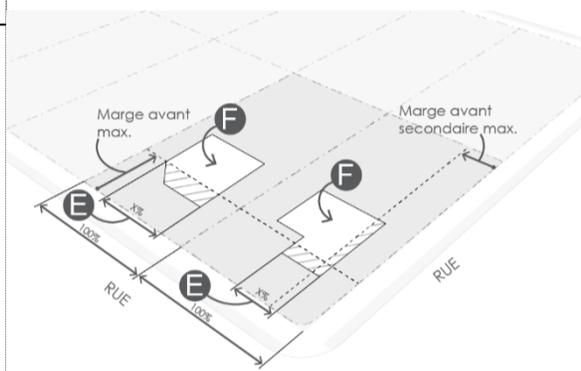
Front bâti et superficie d'implantation au sol d'un bâtiment
